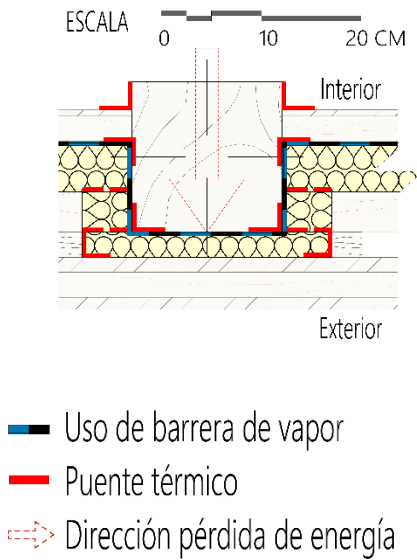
Puentes térmicos en zapata de cimentación y muro (vista en corte).
